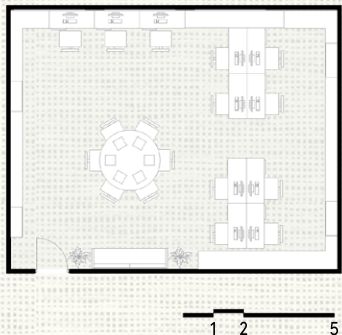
Planta baixa laboratório de pesquisa tamanho 2
